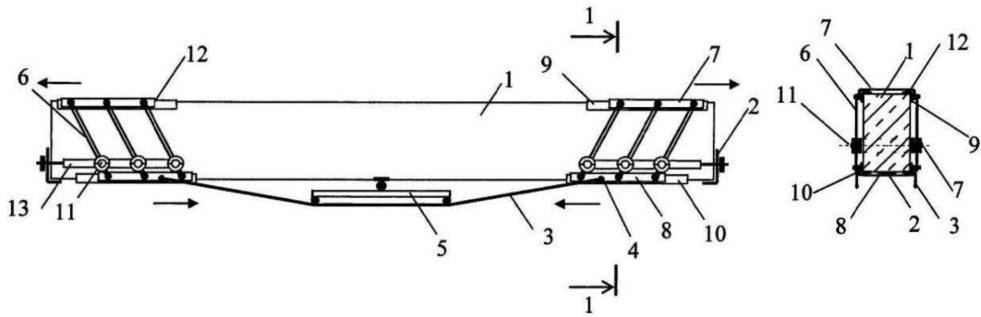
Регульованообтиснена залізобетонна балка: 1 – тіло залізобетонної балки; 2 – закладні деталі; 3 – зовнішня поздовжня арматура у вигляді сталеві затяжки; 4 – кінцеві анкери; 5 – натяжний елемент; 6 – жорсткі хомути; 7 – верхня горизонтальна рама; 8 – нижня горизонтальна рама; 9 – верхня кутова закладна деталь; 10 – нижня кутова закладна деталь; 11 – осі повороту хомути; 12 – антифрикційне покриття у місцях взаємодії закладних деталей балки і рам; 13 – планки осей повороту хомути
